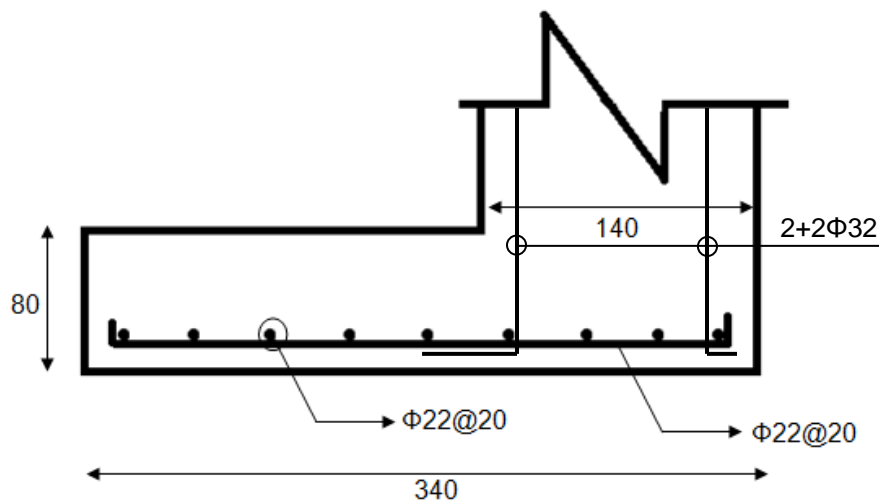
Disposición de la armadura, fundación lado cerro.
